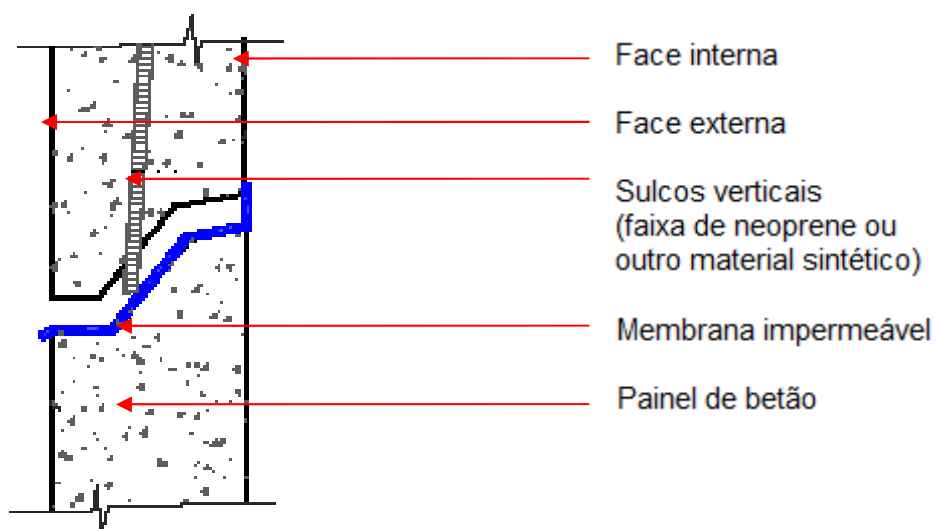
Corte junta horizontal - Esquema de junta de drenagem (Adaptada do PCI, 1989)
